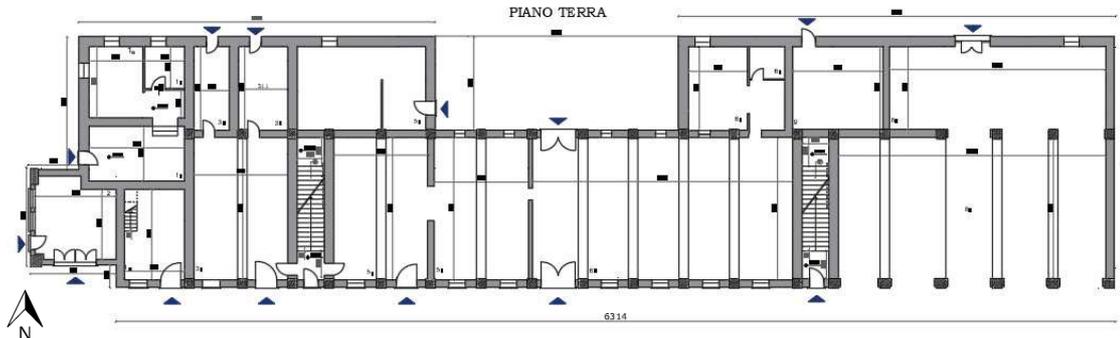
Pianta piano terra, stato di fatto fuori scala.
